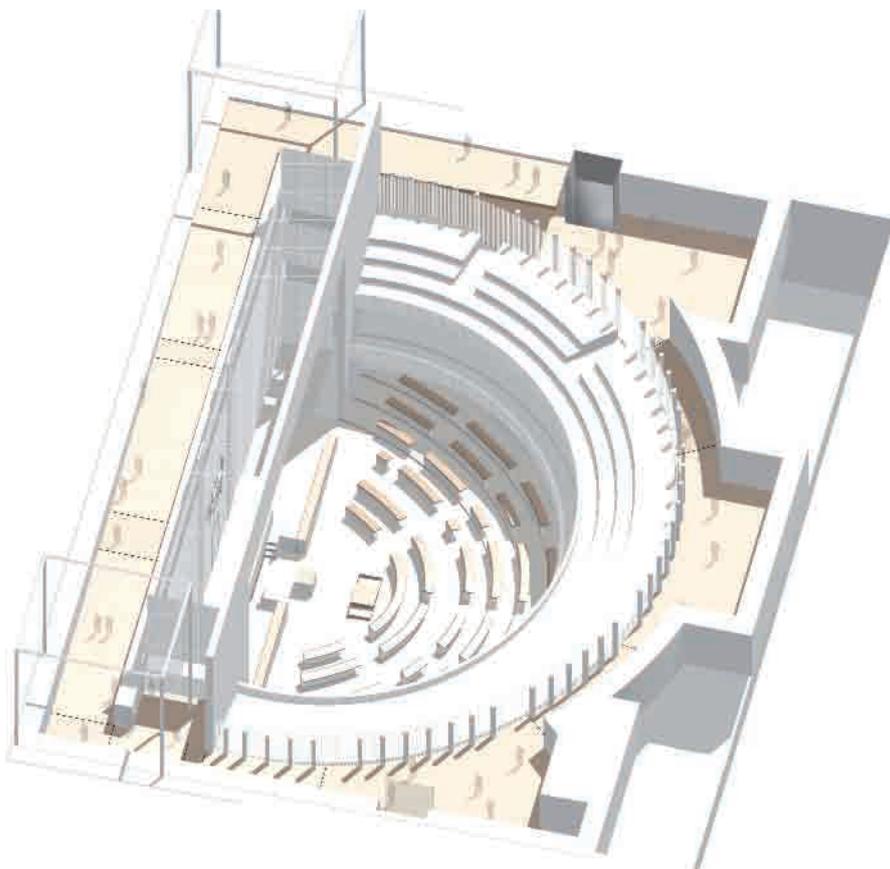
Siegerprojekt (Architekturbüro Heidl), Grundriss
